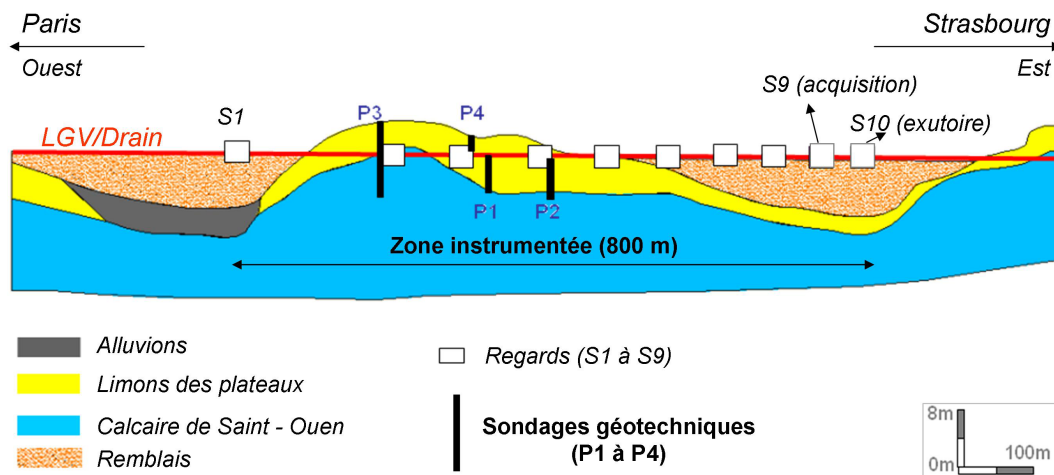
Coupe du sol le long de la voie TGV, position des sondages géotechniques
